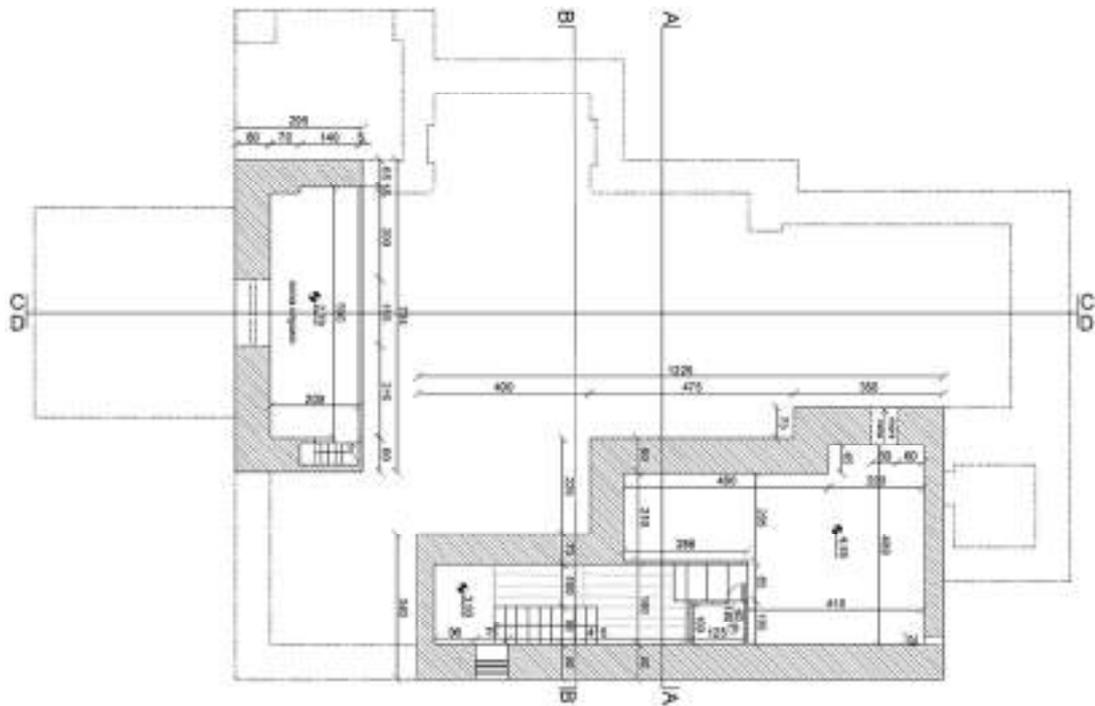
Pianta piano primo (Fonte: Tavola 3B)
